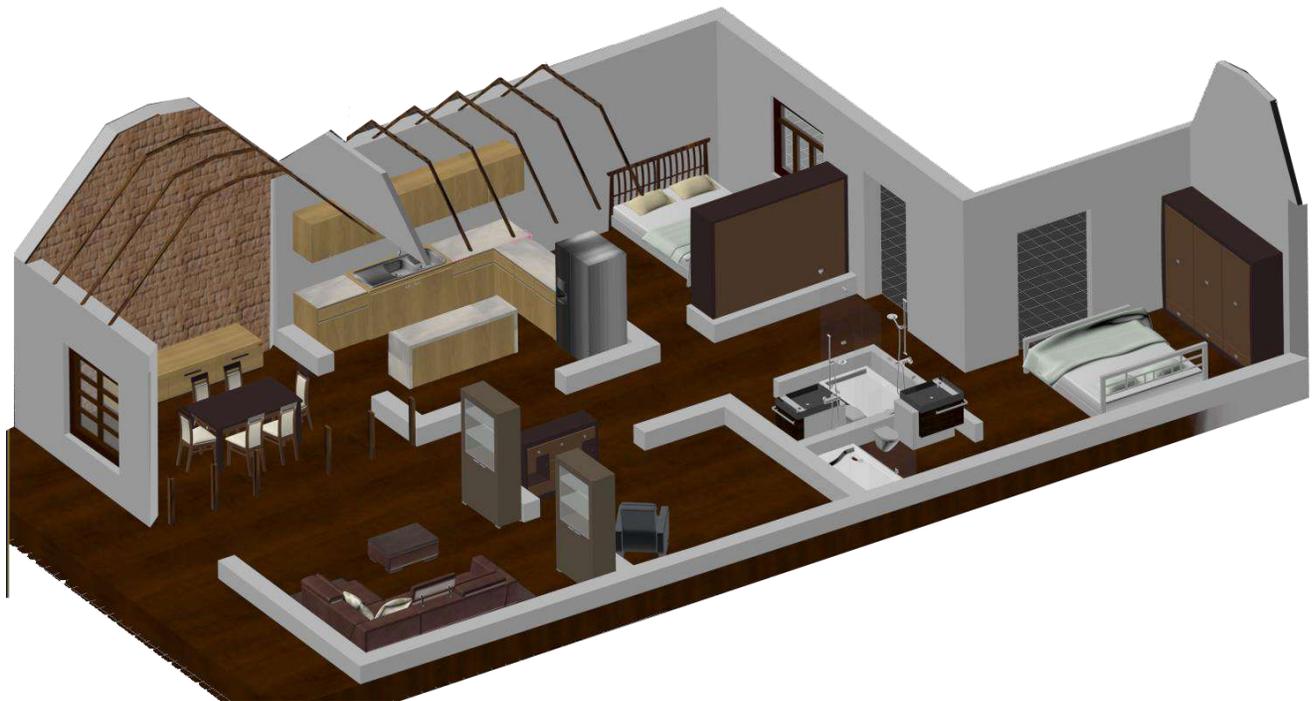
Planta Axonométrica Vivienda 1 Fuente: Elaboración Efren Ventura
